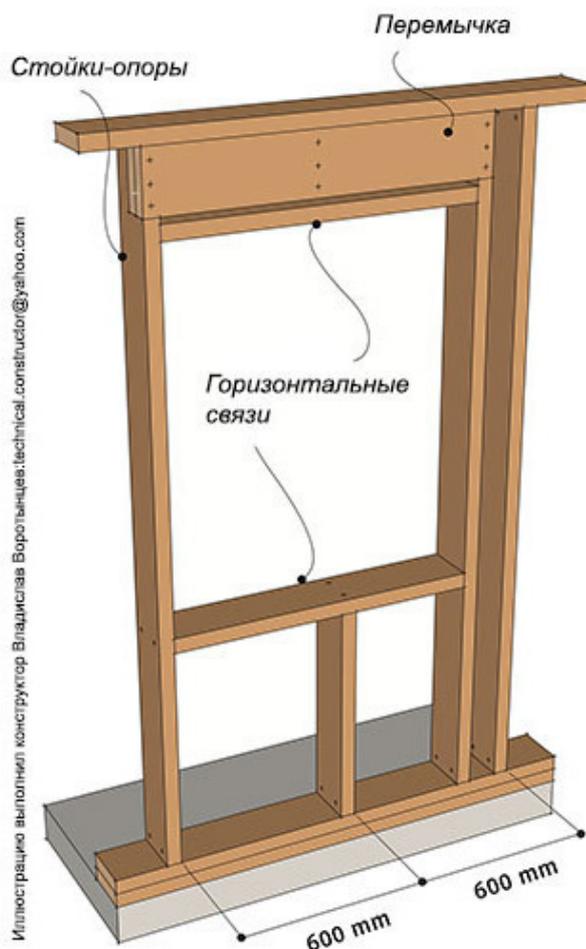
Проём в несущей деревянной каркасной стене с нагрузкой от кровли. Проём типа В
